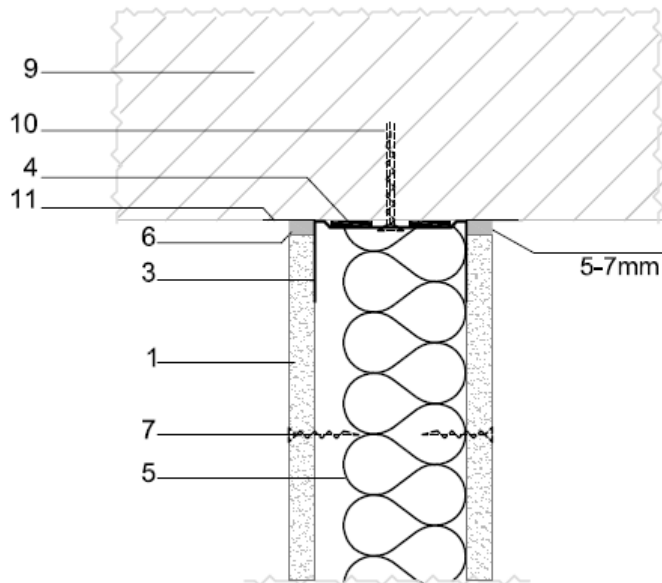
Sección horizontal de un trasdosado con panelado simple.
